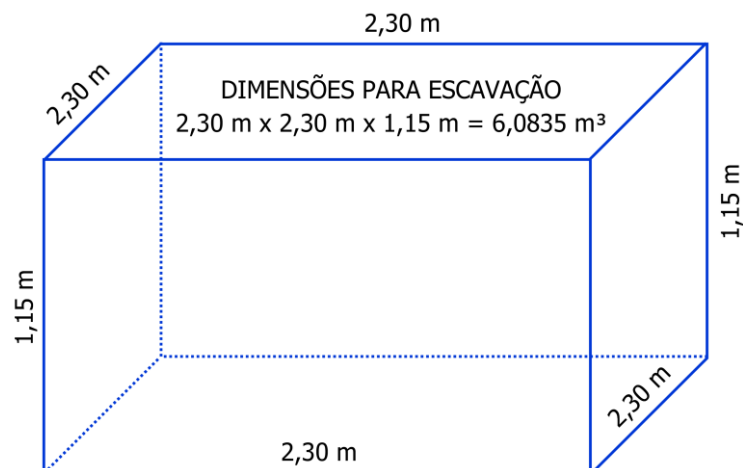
Dimensões para escavação de vala para construção da fossa séptica de evapotranspiração, com 1,15 m de profundidade, 2,30 m de largura e 2,30 m de comprimento, totalizando 6,0835 m³ de escavação.
